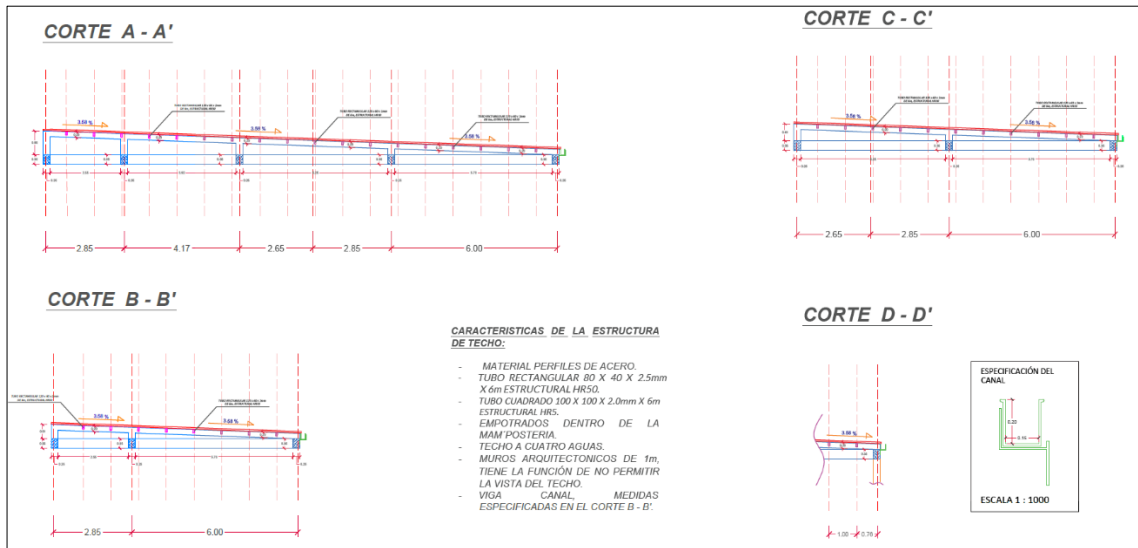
Corte arquitectónico A-A', B-B', C-C', D-D' de la estructura 2 del Centro Vida.
